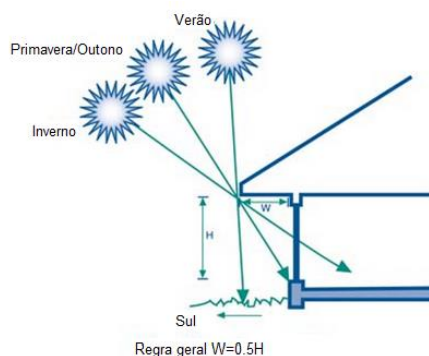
Exemplo de dimensionamento de coberturas para fachada Sul. Fonte: [58] adaptado.
